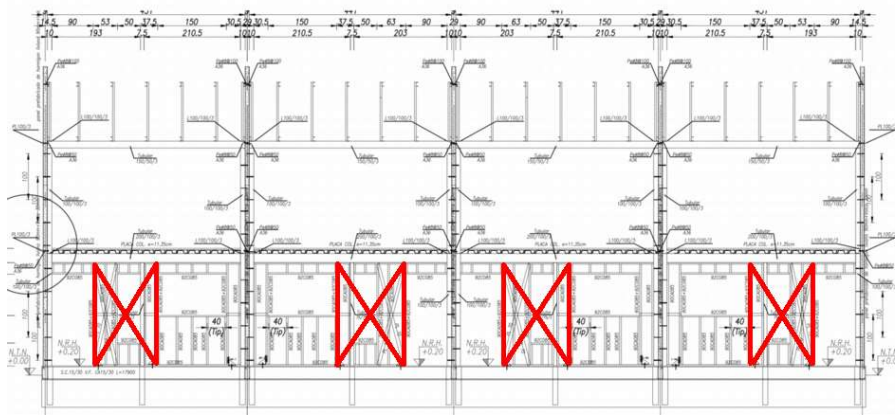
Eje tipo de Metalcon, incorporación de arriostramiento en acero estructural.
